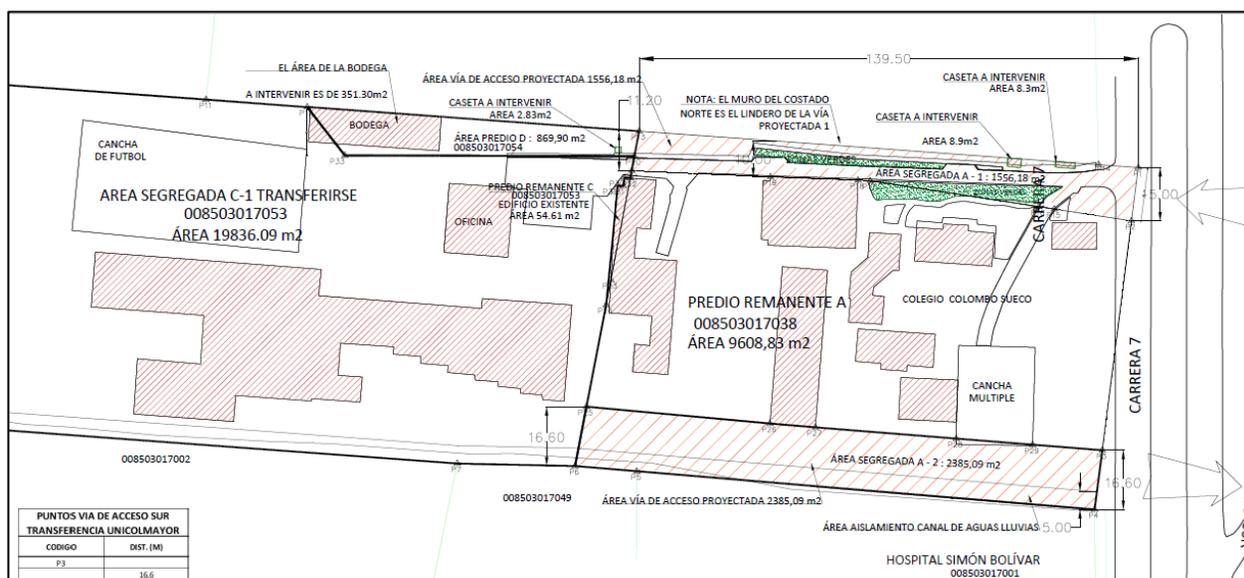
áreas estimadas sobre Lote A, para acceso a proyecto Nueva Sede
